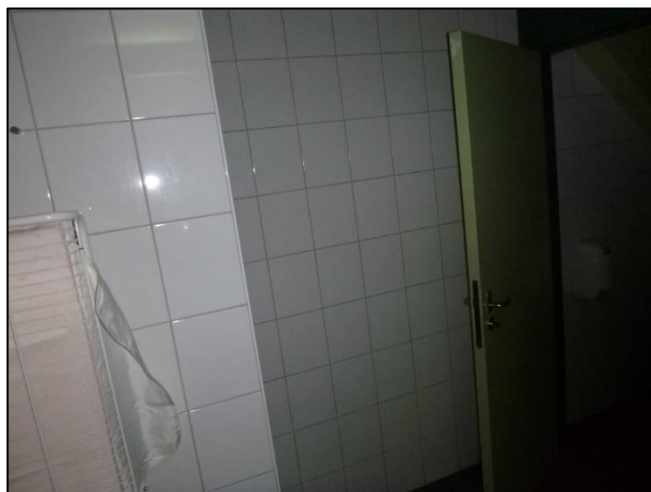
Toiletten, wanden: Tegellijm (Ontoegankelijk)
